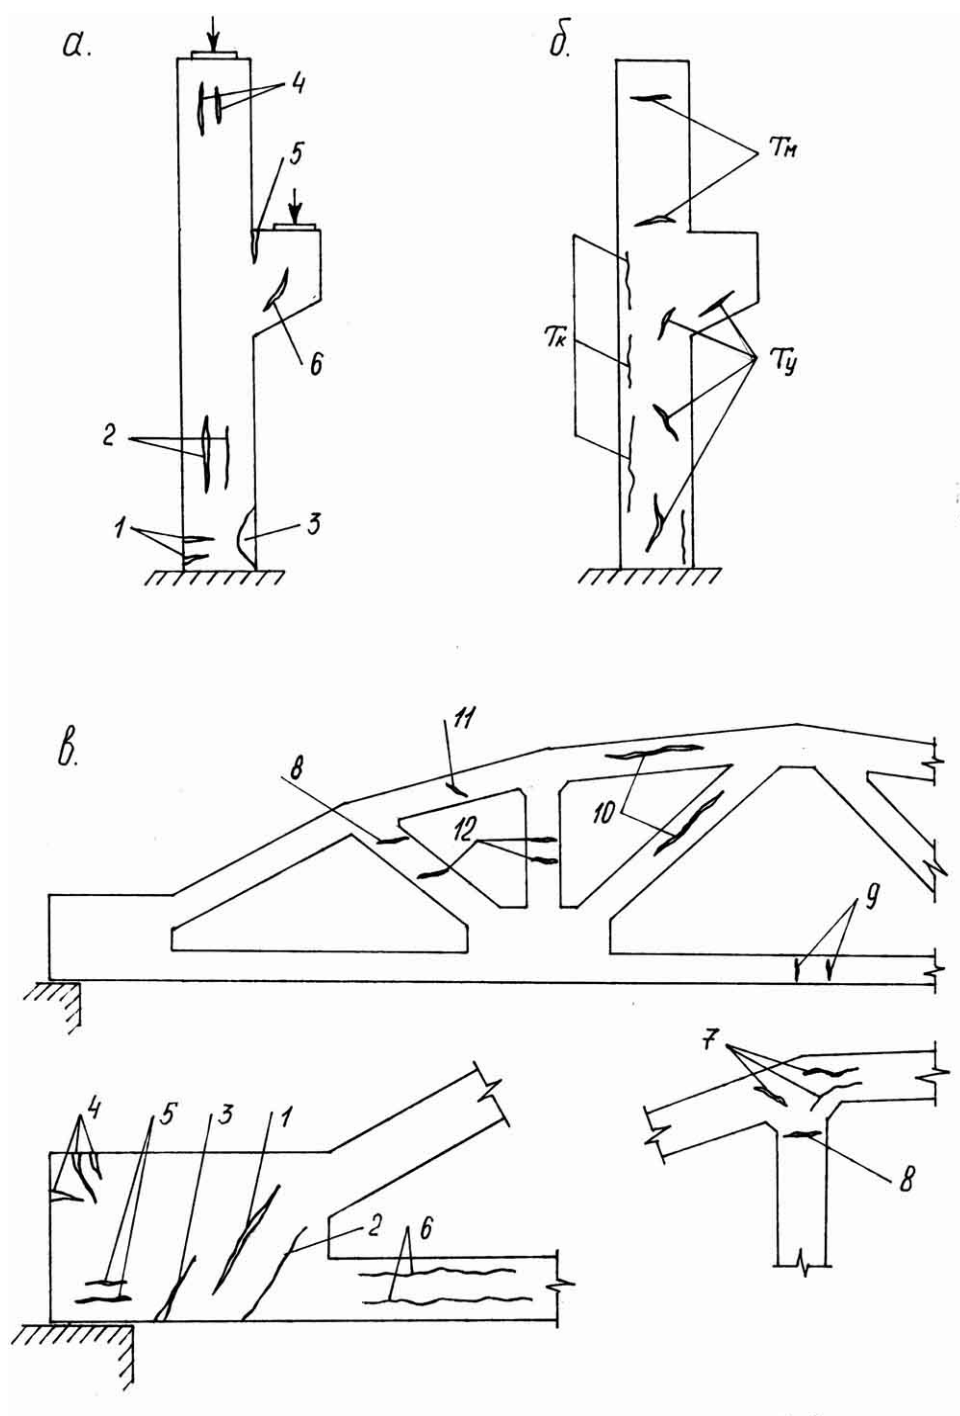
Трещины в колоннах и стропильной ферме:
